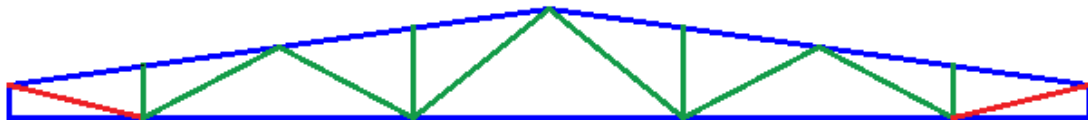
Disposición de perfiles de tubo cuadrado hueco
